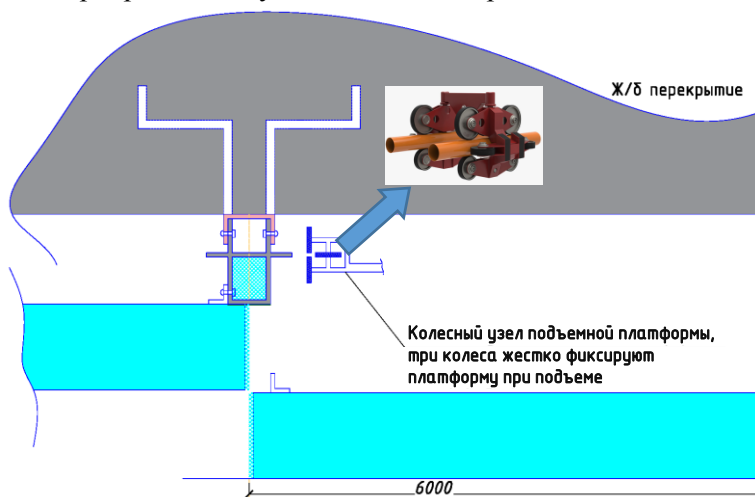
Метод монтажа модульных фасадных элементов «Фасадная вагонетка»
